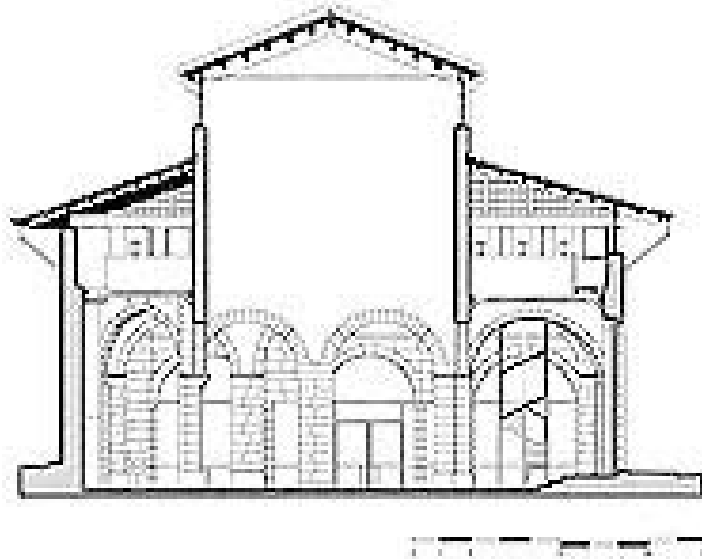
Sección transversal. Fuente Web: ViA arquitectura
